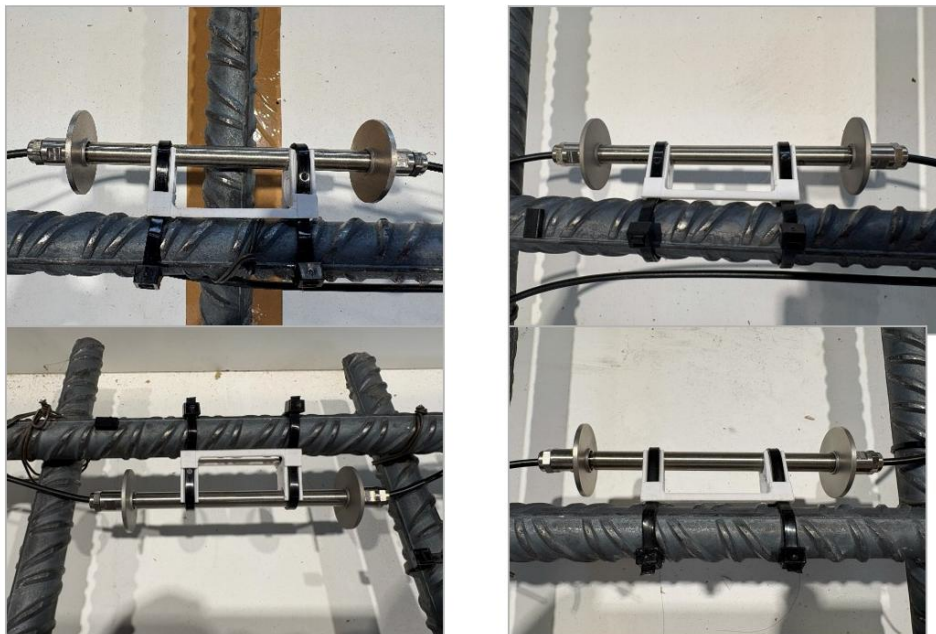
Instalación de sensores ópticos FBG sobre las armaduras de la losa de ensayo.
